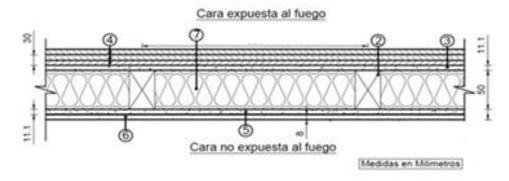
Vista en corte solución propuesta (a asimilar) – Tabique perimetral 14
